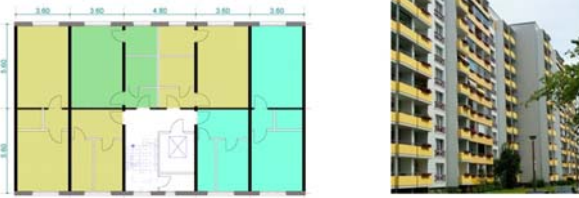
Germania, QP64 – plan, QP71 – foto
